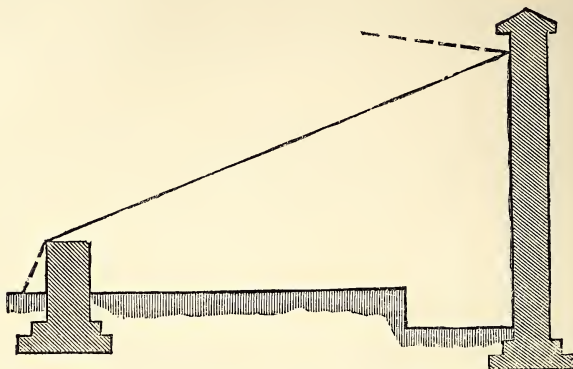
Vaste serre adossée à toiture surbaissée.
